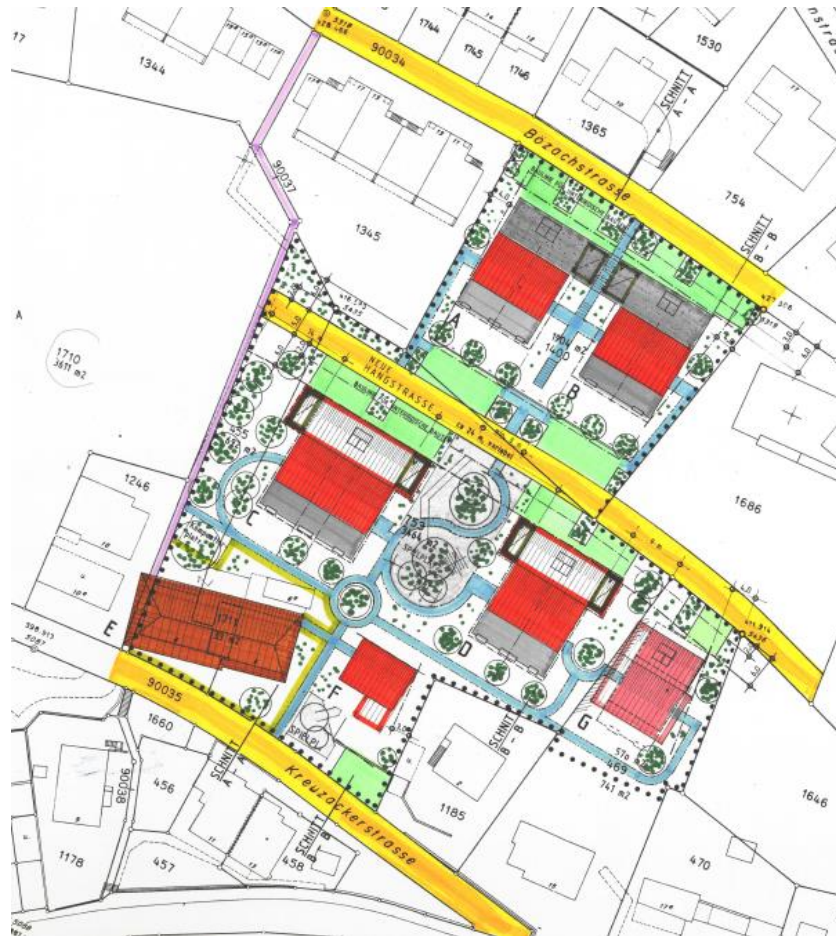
Gestaltungsplan Gebiet B Bözachstrasse Süd
